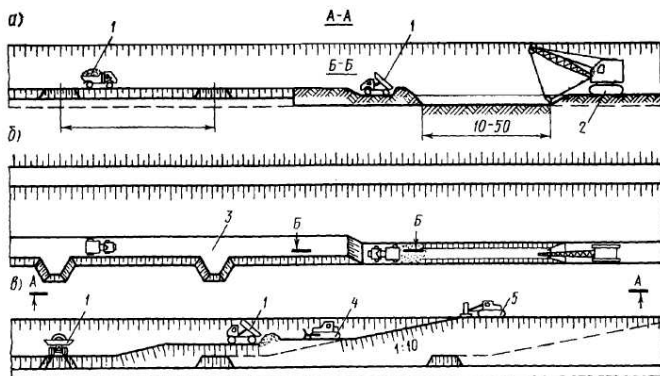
Схема отсыпки насыпи на болоте с однополосным производством работ (размеры в метрах): а – продольный разрез; б – план; в – уплотнение грунта машинами реверсивного типа; 1 – автосамосвал; 2 – драглайн; 3 – разезд; 4 – бульдозер; 5 – грунтоуплотняющая машина
